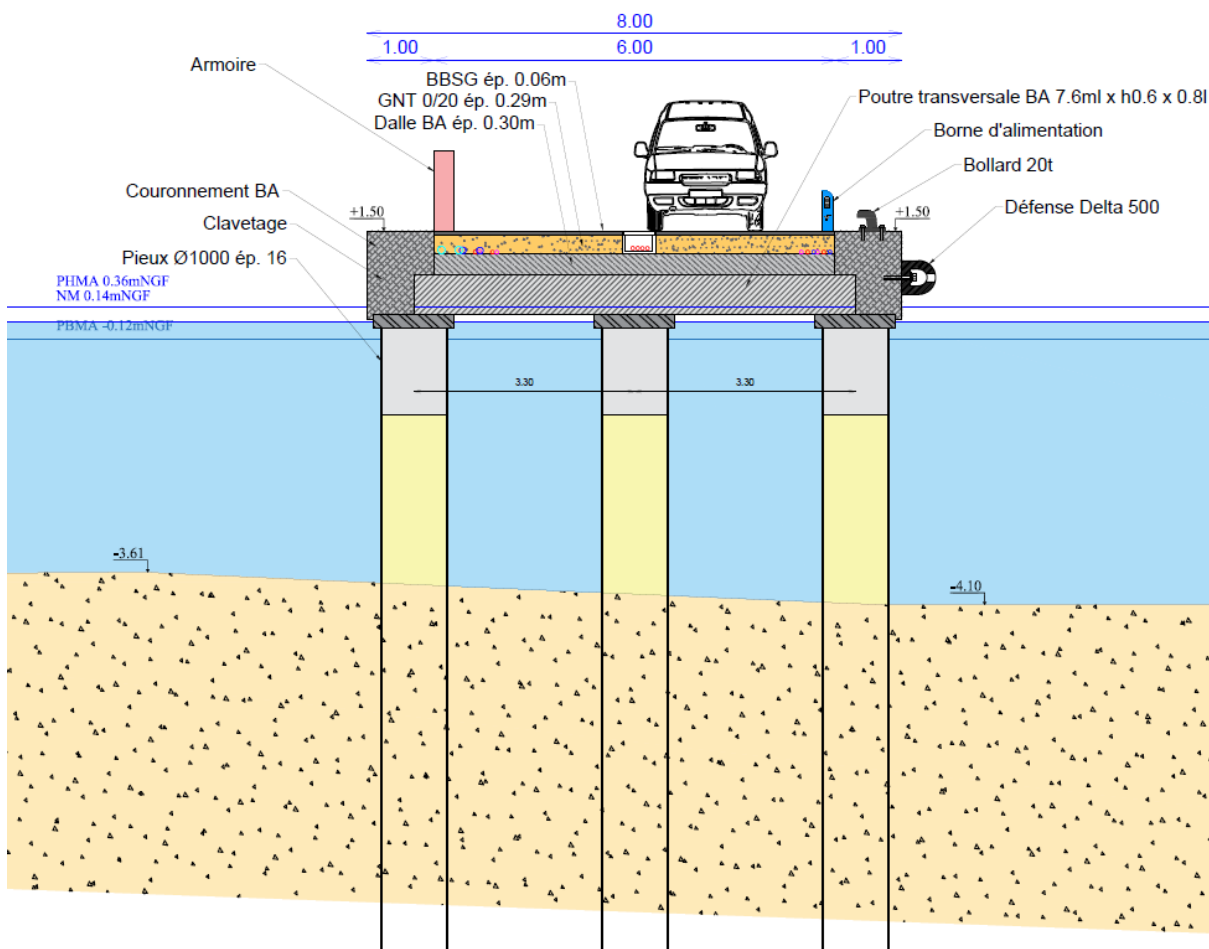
Coupe de principe de l'ouvrage sur pieux (SUEZ, AVP 2024)
